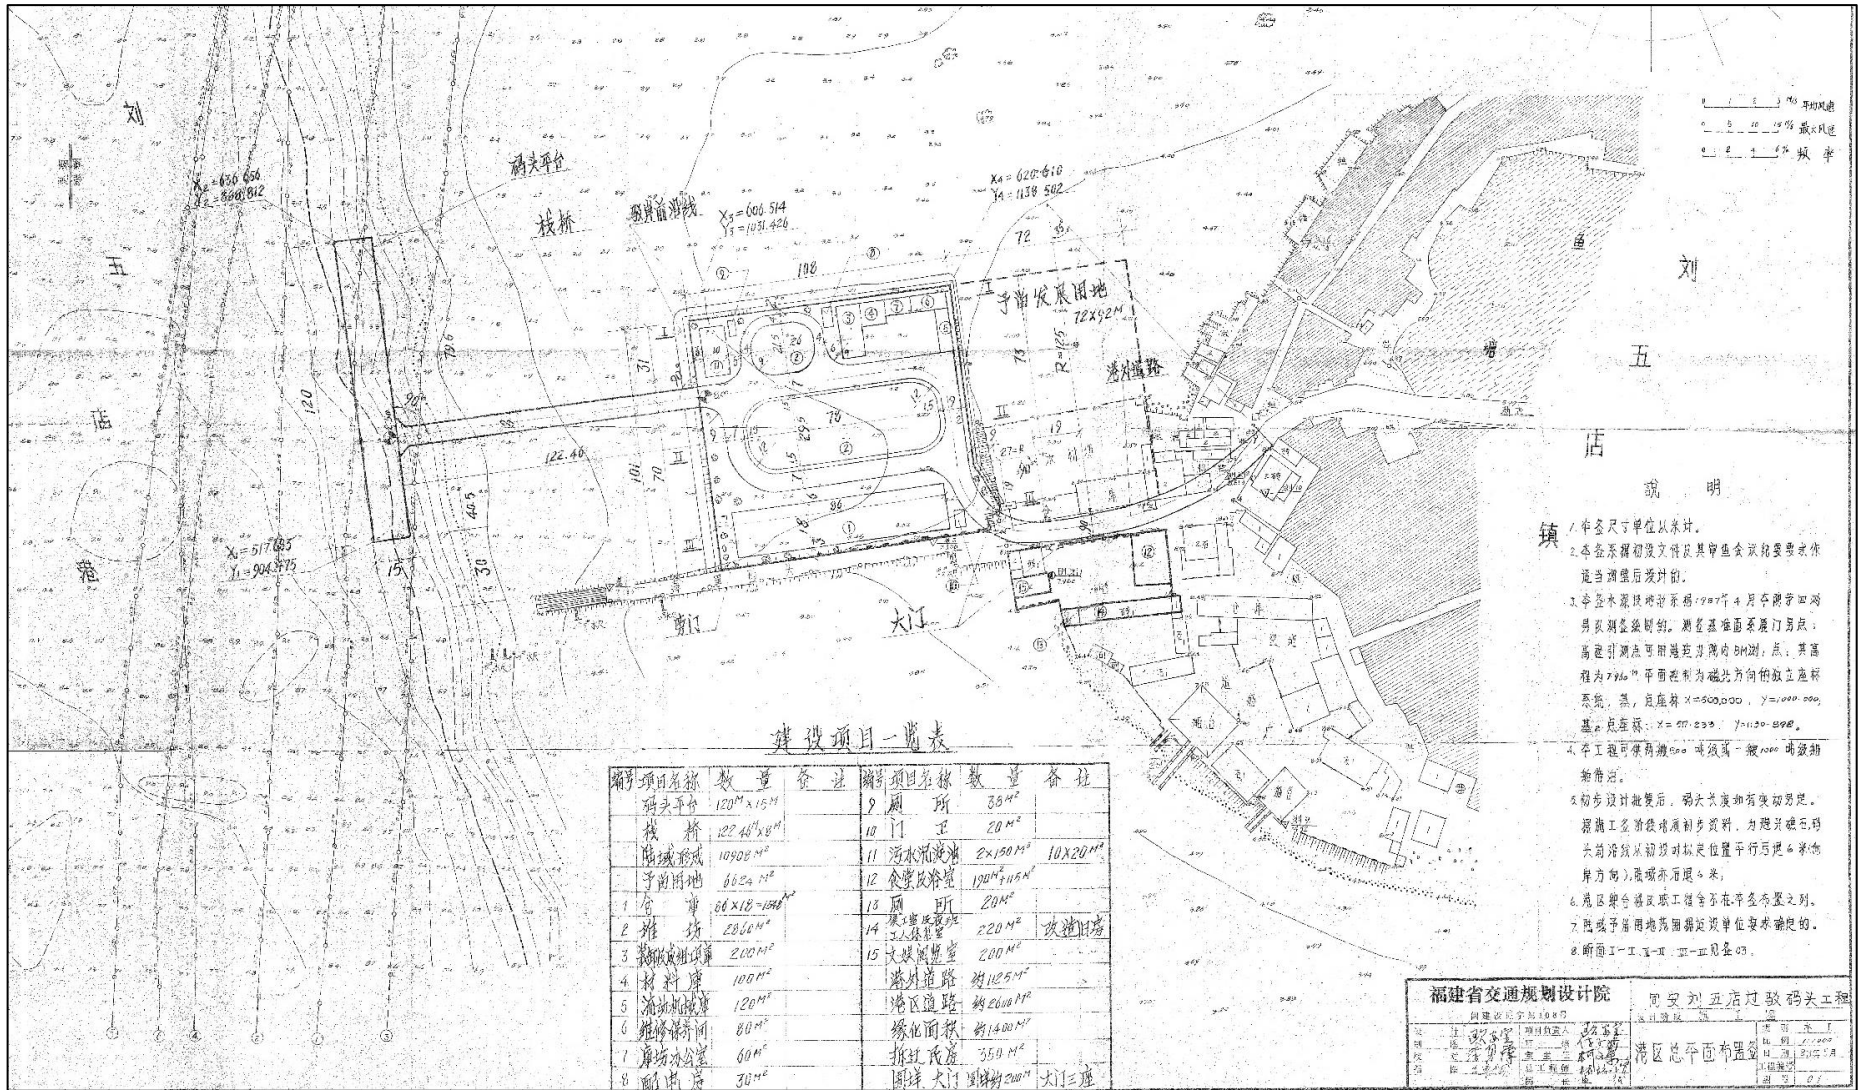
刘五店过驳码头现状平面布置示意图
